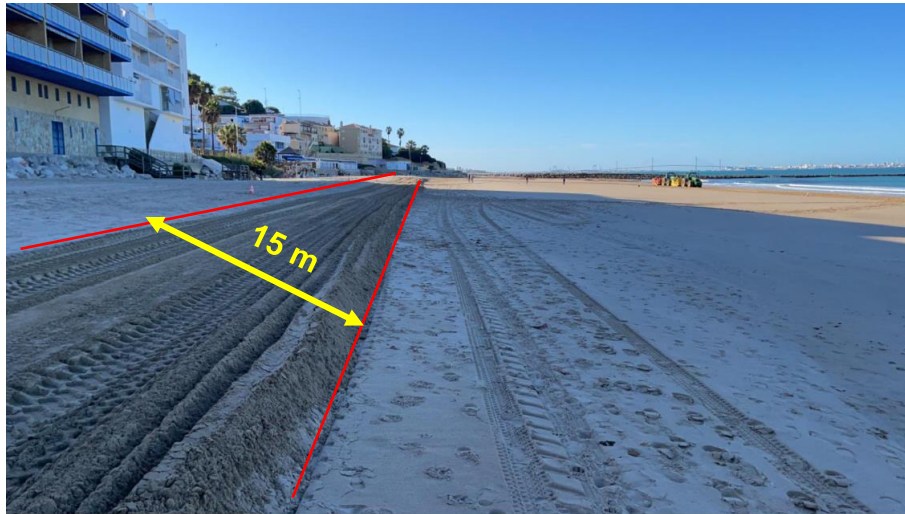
Zona de vertido del scraping, esta zona consta de 15 m de ancho (entre las líneas rojas). Fotografía cortesía del proyecto BeachArt- IH.
